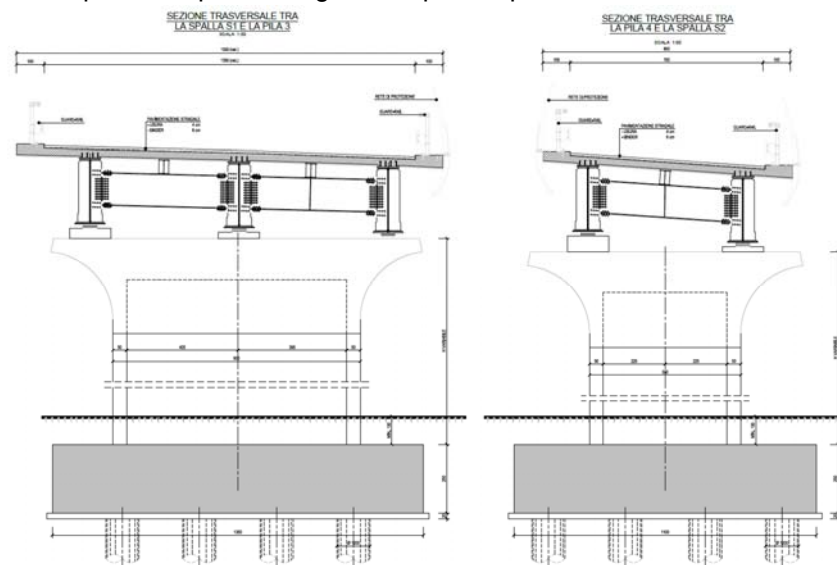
Viadotto Matera Sud Rampa 3: sezione impalcato/pile (le due tipologie)
